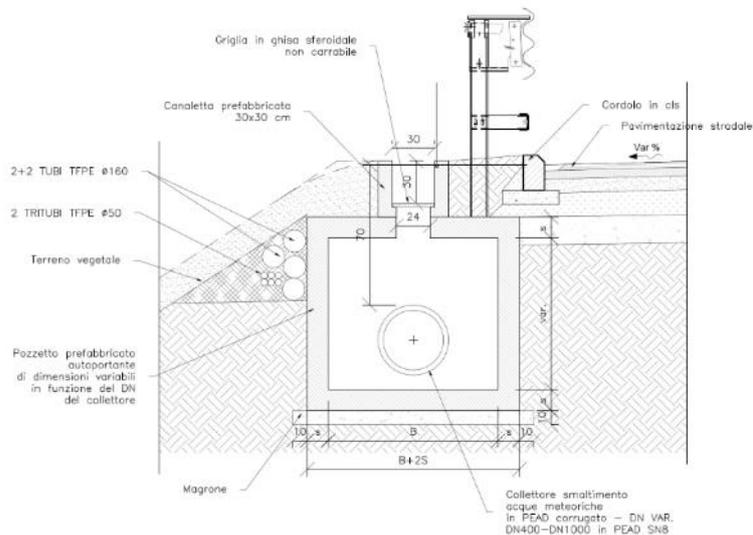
Sezione in corrispondenza del pozzetto.
